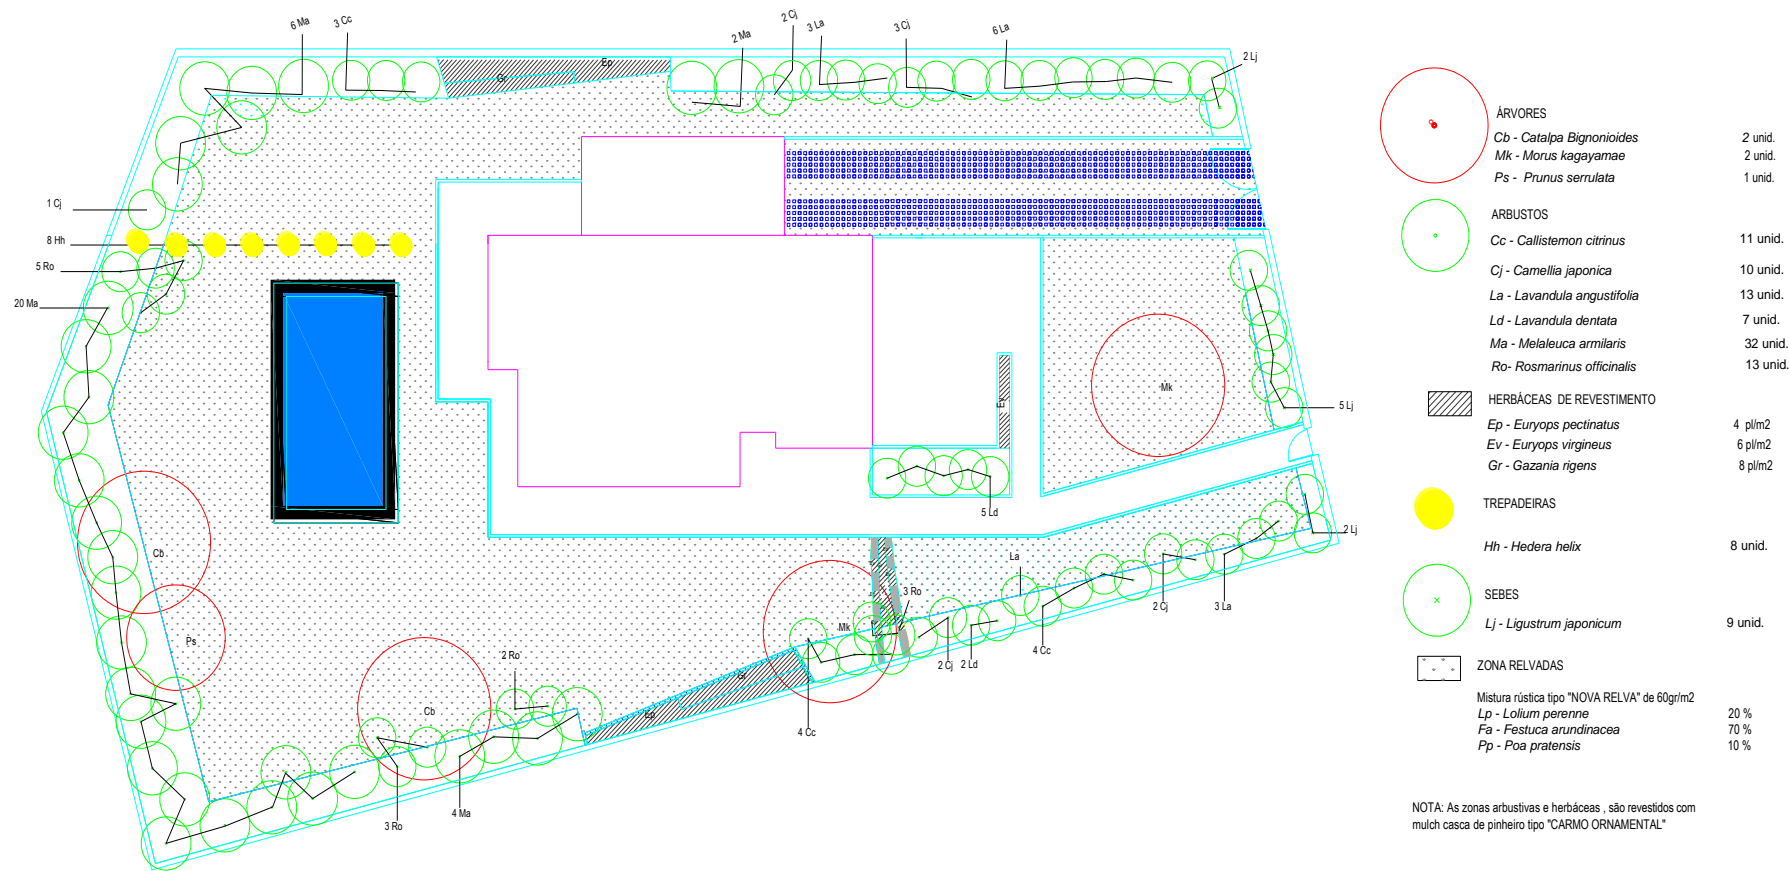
Plano de plantação referente à situação A - Porto.
